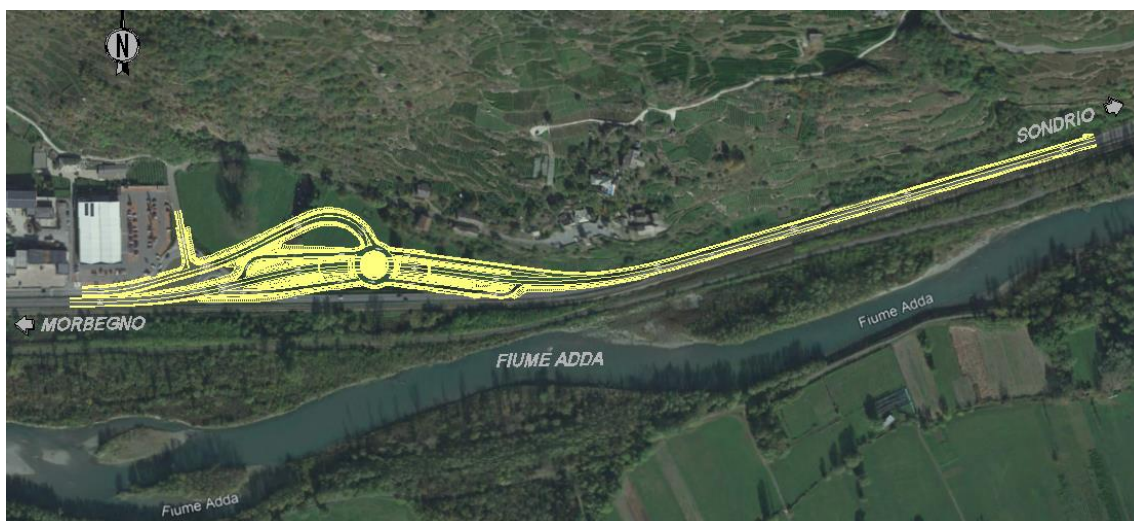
Area di progetto con sovrapposizione intervento di progetto
